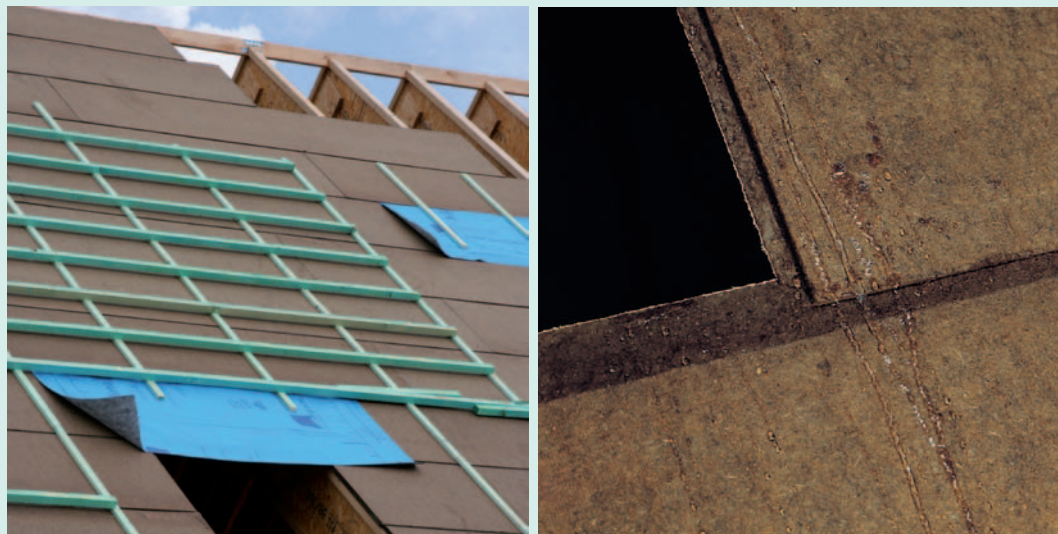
Sous-toiture sous forme de plaques en fibres-ciment.
